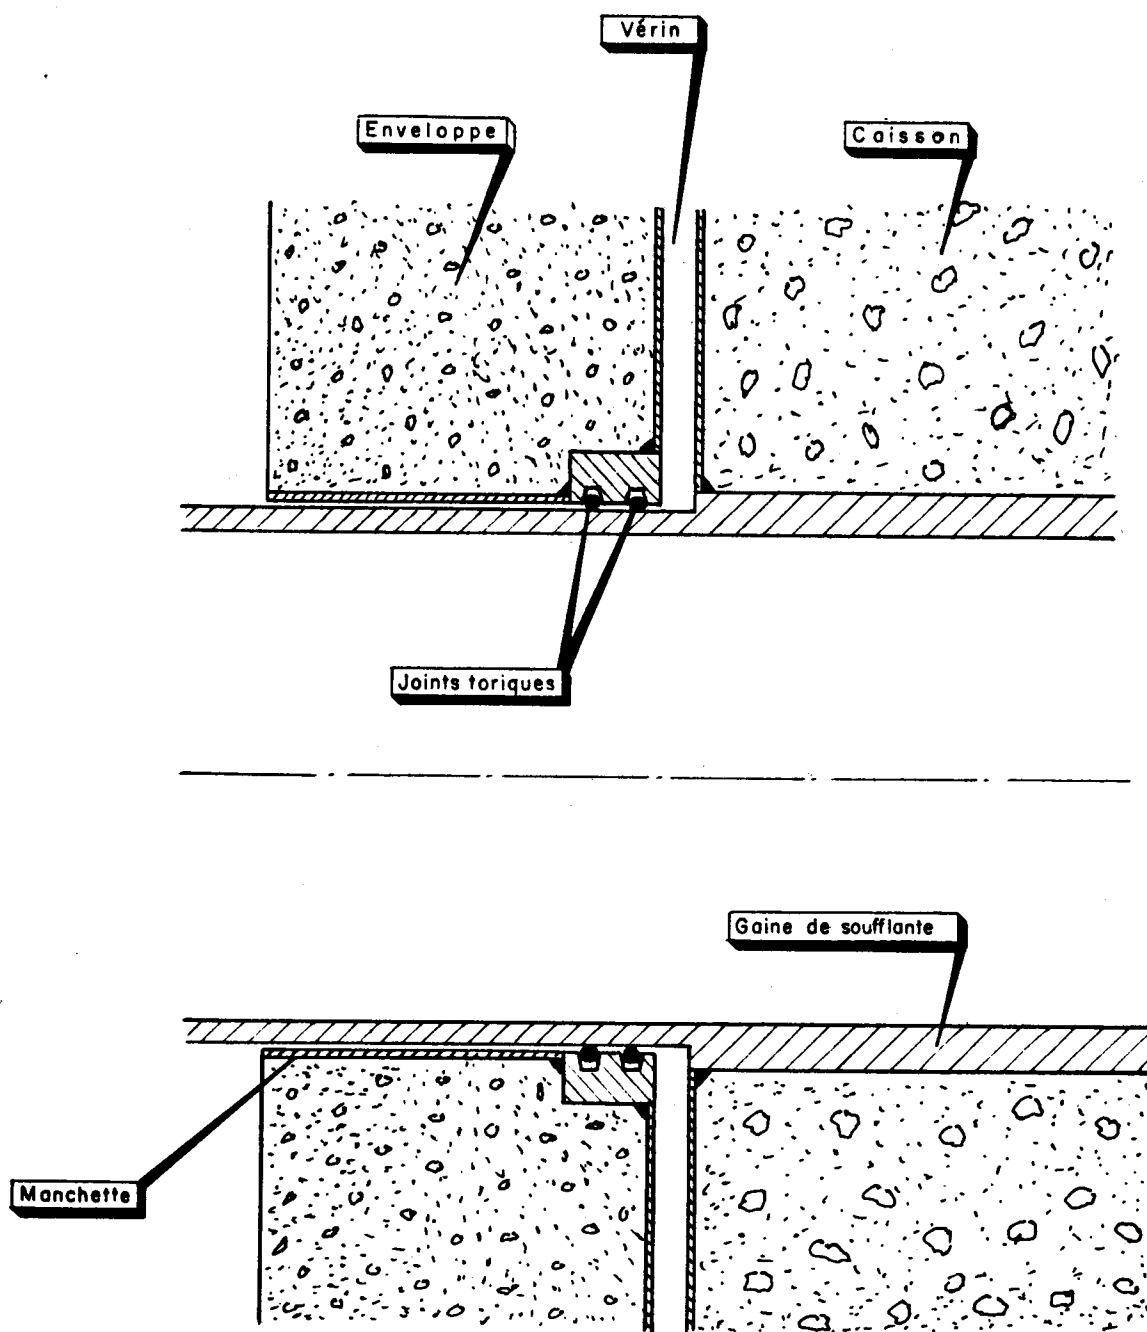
COUPE VERTICALE DANS L'OUVRAGE
